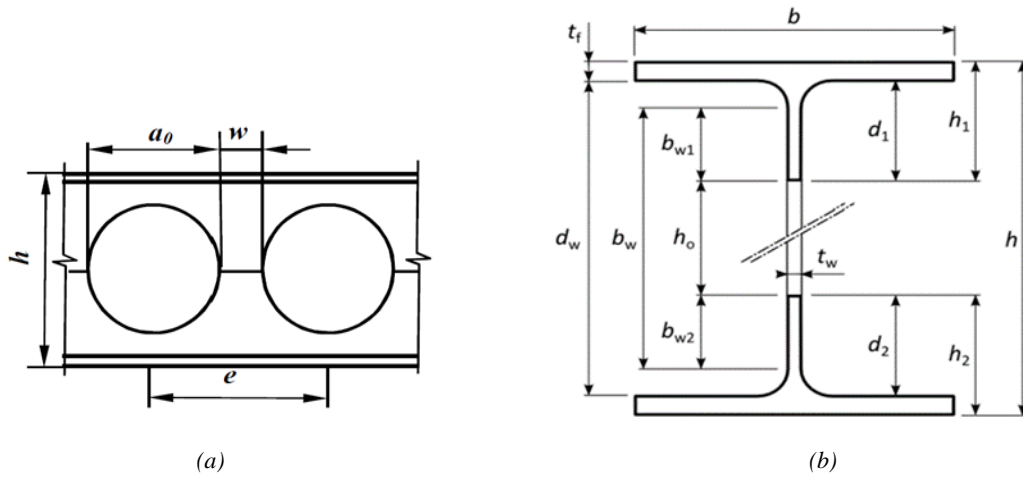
(a) dimensions d'ouverture d'âme multiple[6] (b) la section transversale[46].
